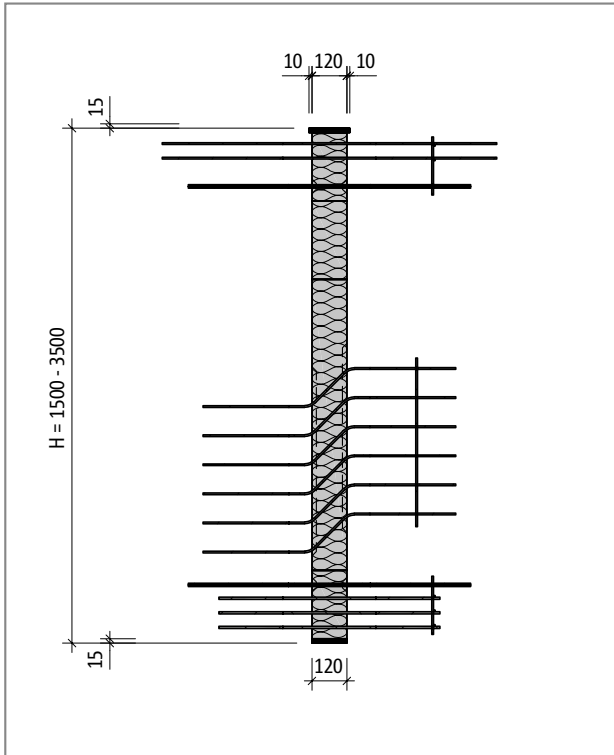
Schöck Isokorb® XT Typ W-M1: Produktschnitt
